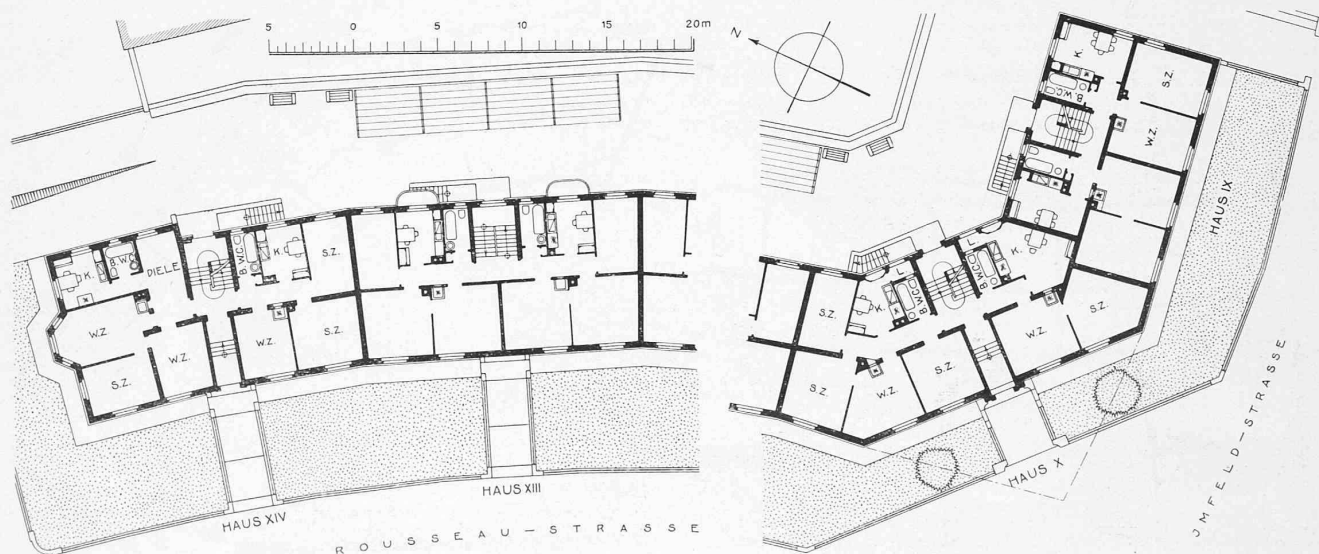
Grundrisse der Häuser IX bis XIV der Wohnkolonie Letten des eidgen. Personal's, an der Rousseaustrasse in Zürich. — Masstab 1 : 400.
